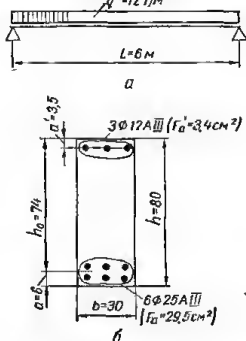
Расчетная схема (а) и поперечное сечение железобетонной балки (б).
